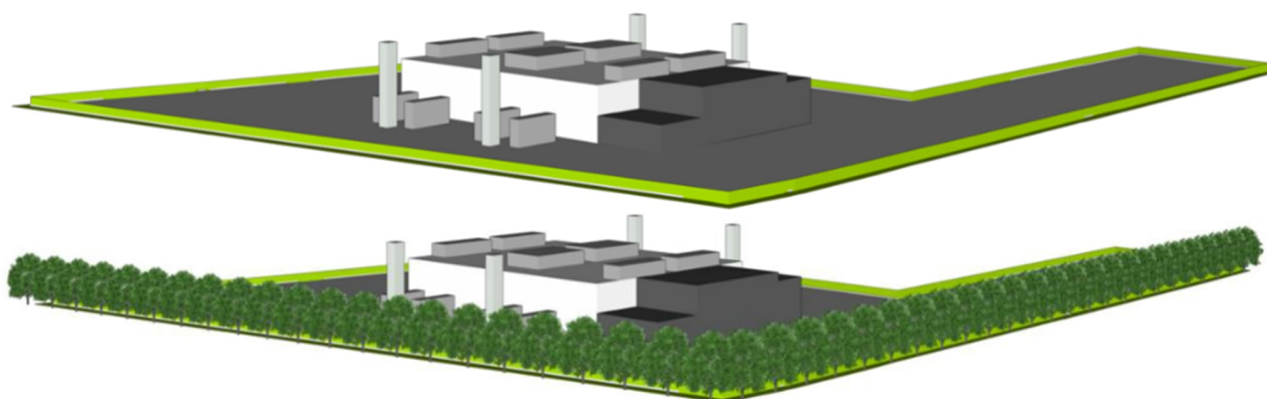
ricostruzione 3D delle volumetrie degli impianti del nuovo Data Center 3D (immagine in alto) e delle misure di mitigazione a verde (immagine in basso) previste lungo il lato sud ed est del perimetro. La prospettiva è con vista nordest-sudovest.
